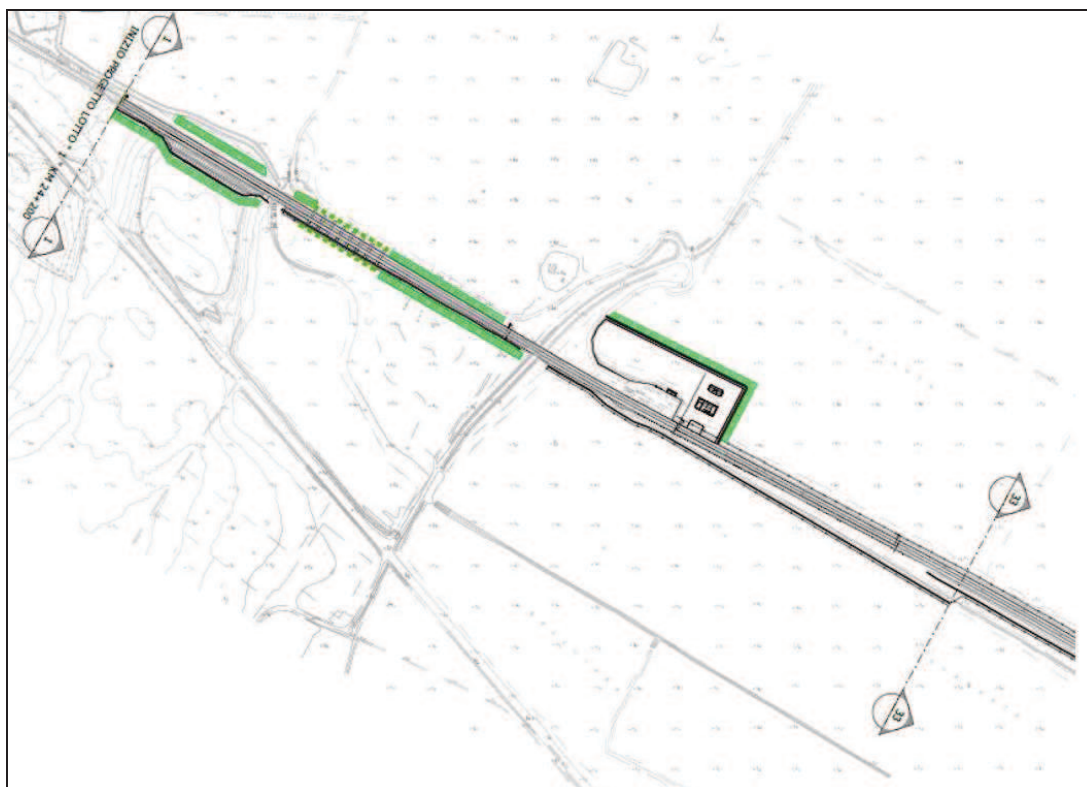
Localizzazione interventi di mitigazione delle opere a verde
